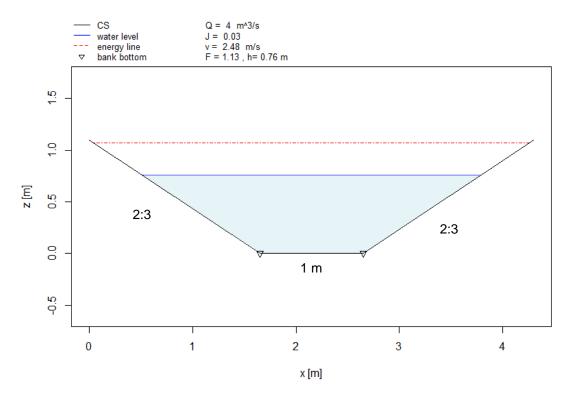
Profil en travers du canal de jonction entre le ruisseau existant et le nouveau ruisseau
